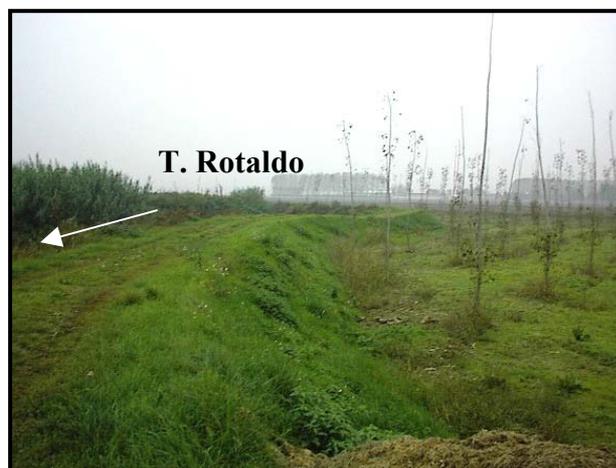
Vista da valle dell'argine in sponda sinistra, a monte dell'attraversamento del Lanza.
